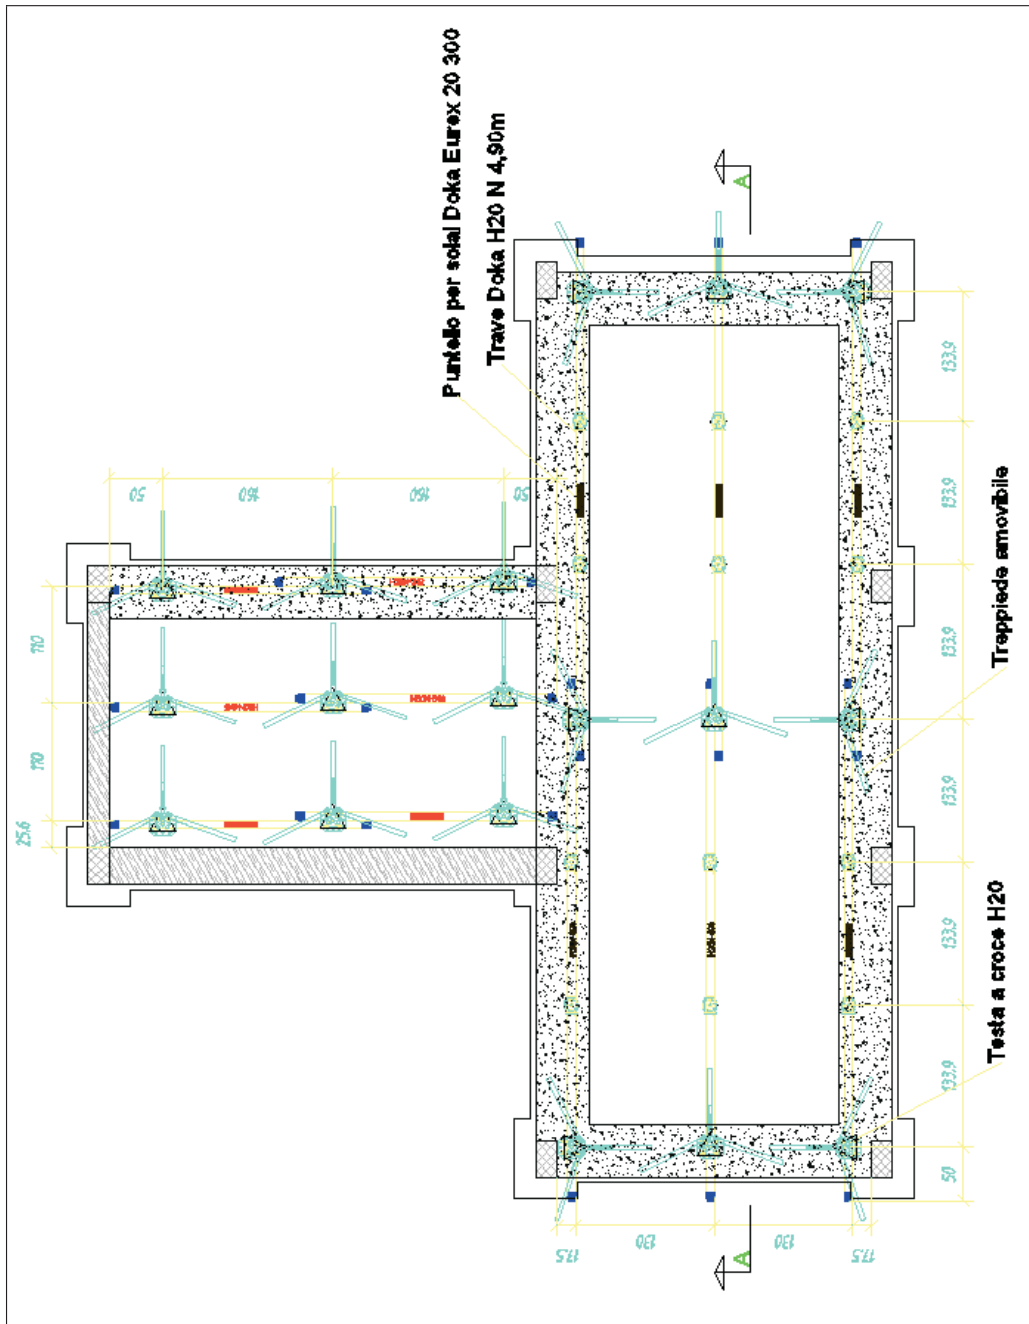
Planimetria del banchinaggio dell'orditura primaria
